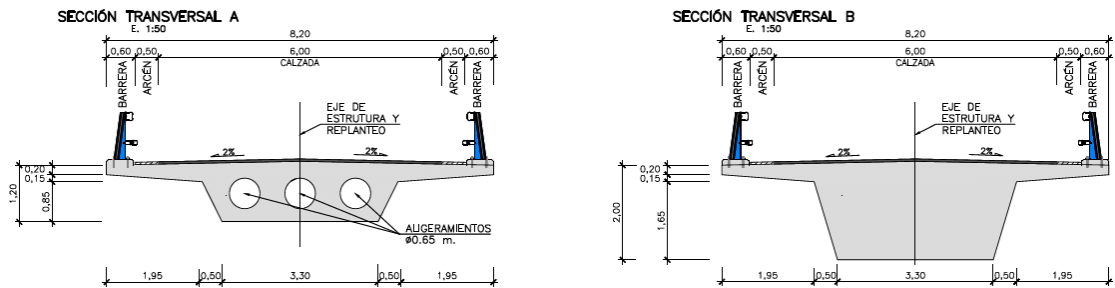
Sección tipo P.S. 2.5 (por centro de vano y por pilas)
